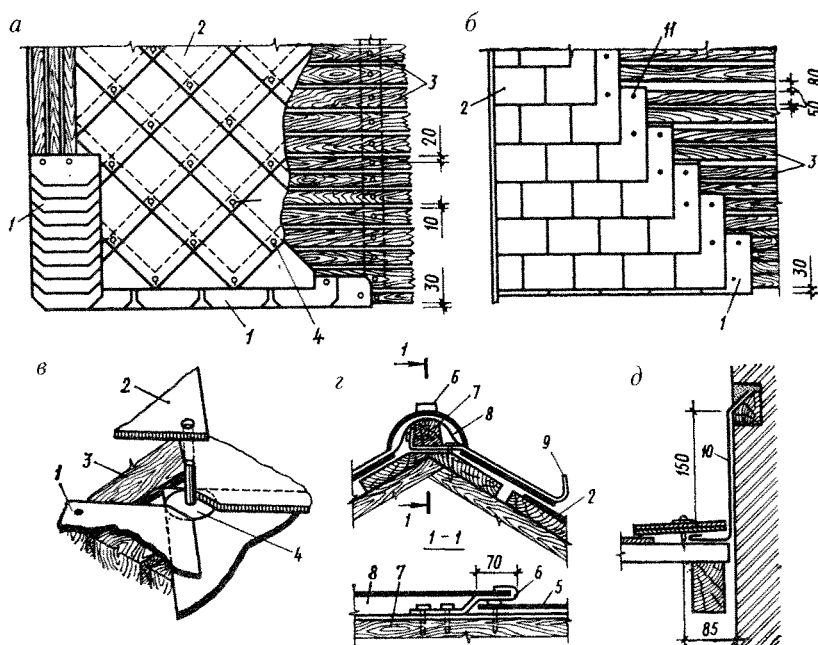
Кровля из плоских асбестоцементных плит (шифера):
